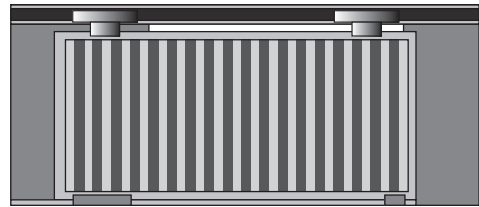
Схема откатных ворот с верхней или нижней опорной балкой
